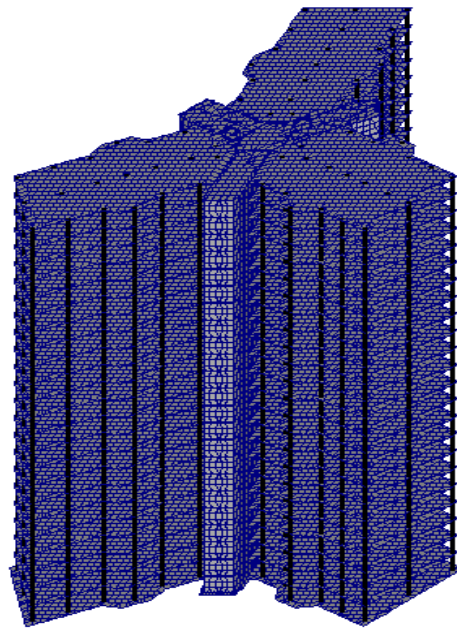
Розрахункова схема будівлі в ПК МОНОМАХ
